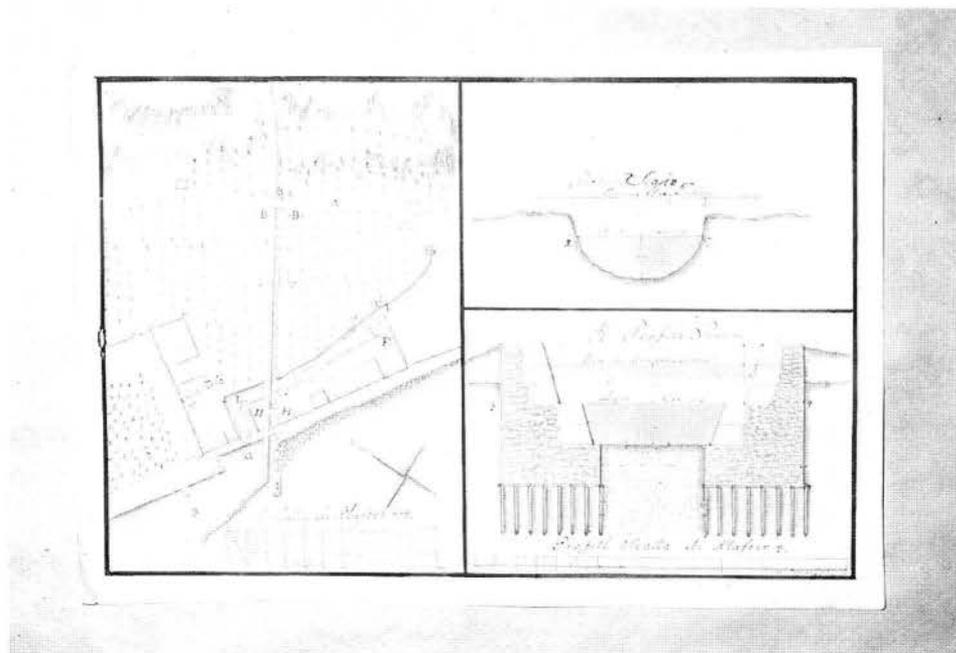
Piano con le sezioni dei corsi d'acqua "Scurigine" e "Braida" (de Bonomo), DAR, Collezione di planimetrie, num. 228.
